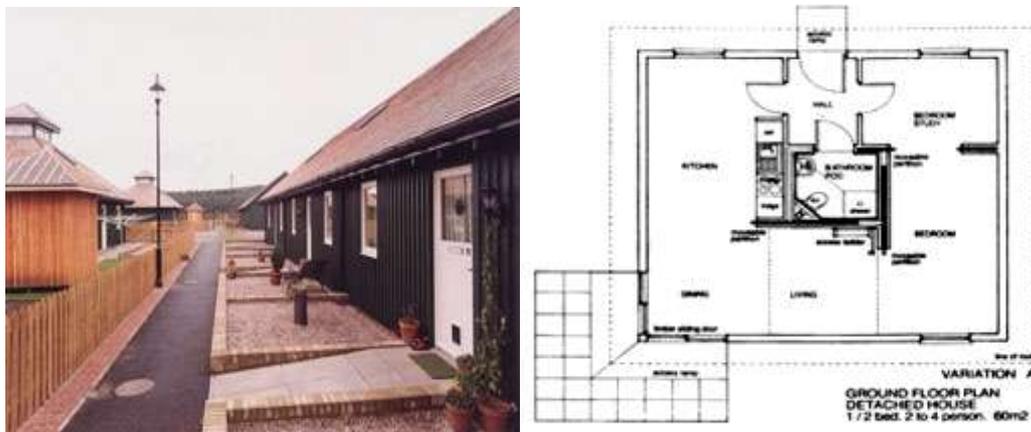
The Affordable Rural Housing Demonstration: a) Vista exterior: b) Planta (Disponível em: <http://www.afewthoughts.co.uk>).
